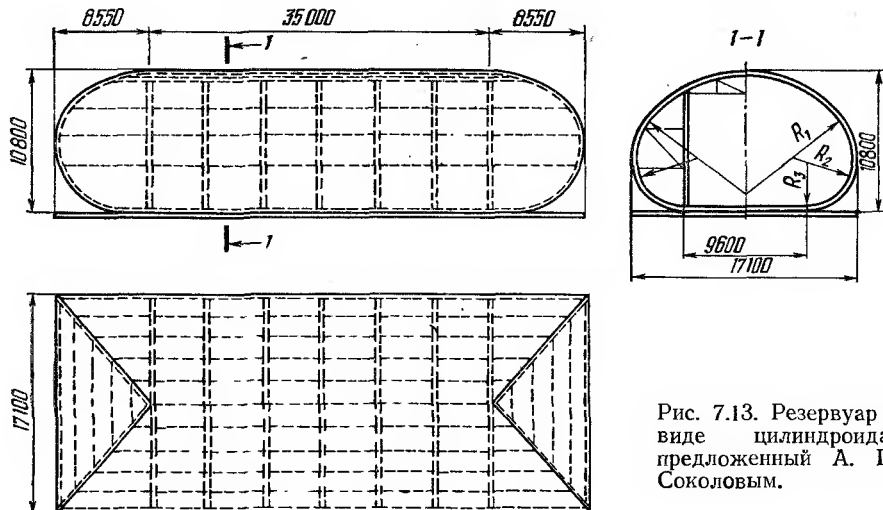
Резервуар в виде цилиндрида, предложенный А. Г. Соколовым.
